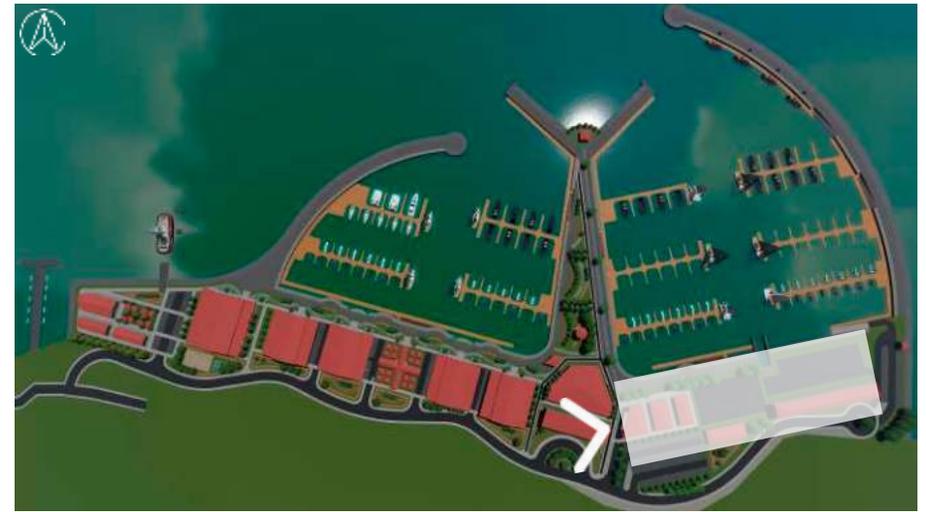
Fase D de la propuesta del Plan Maestro Marina Turística Punta Piedra Amarilla.
